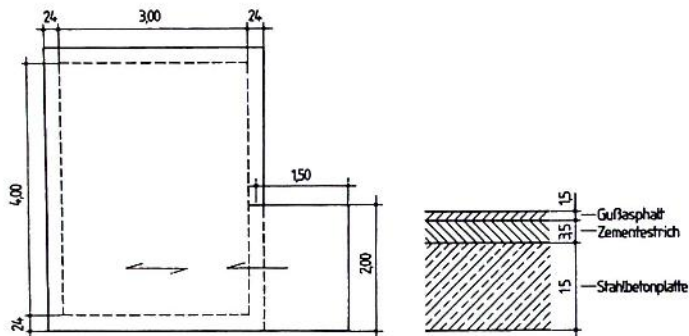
Stahlbeton-Kragplatte für einen Balkon
